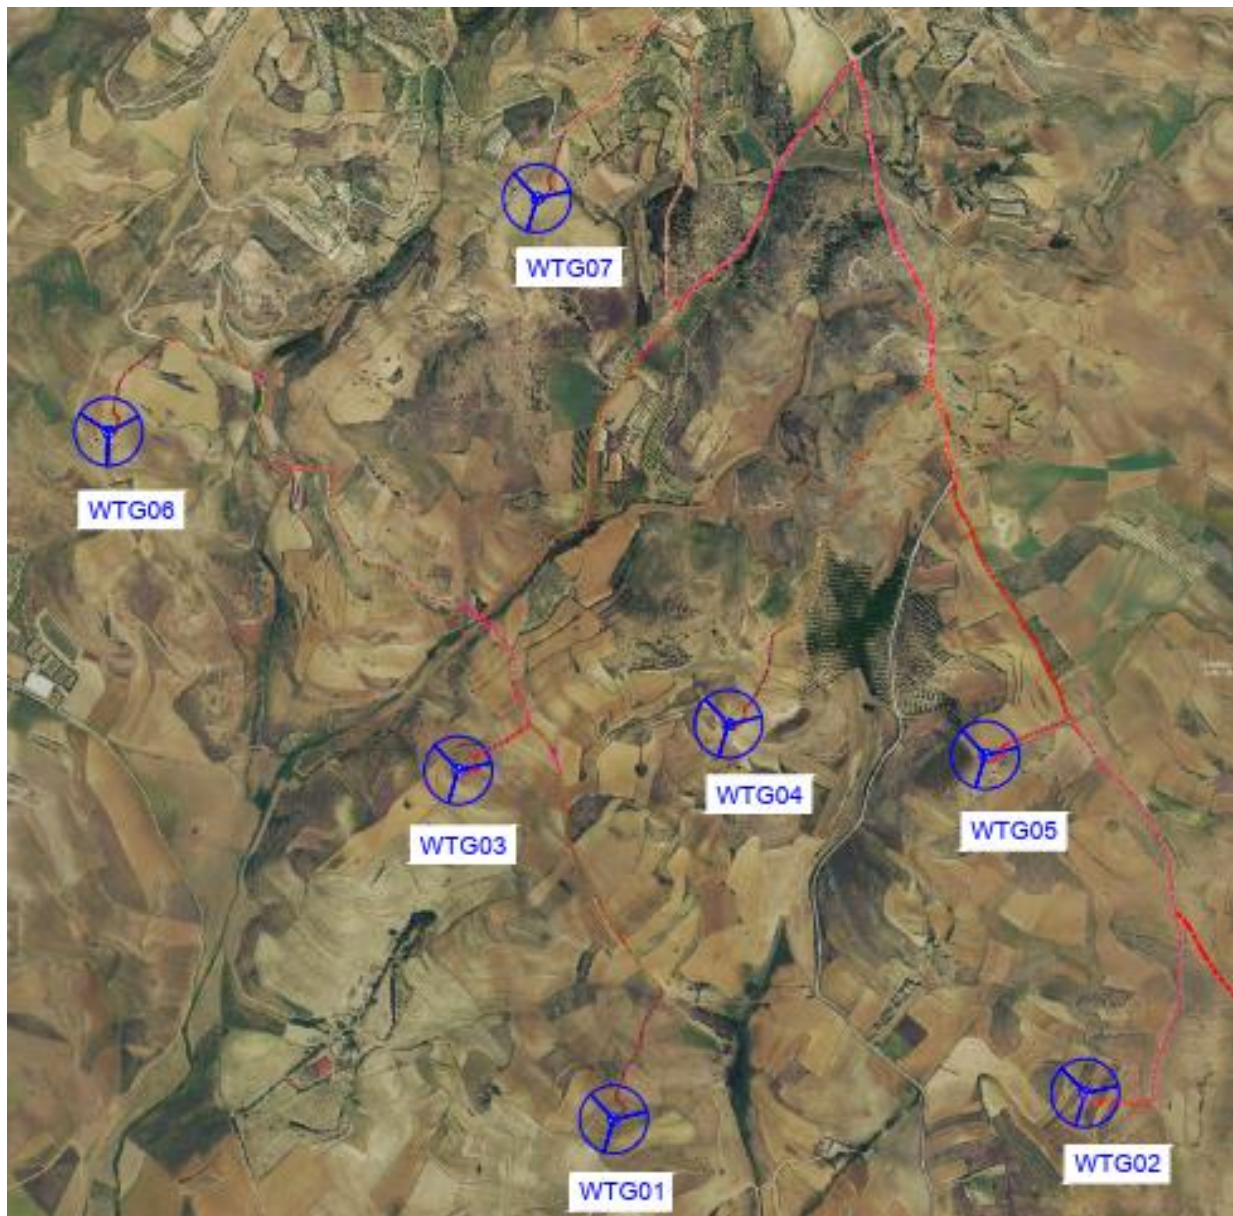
Layout della rete MT su ortofoto - impianto eolico
